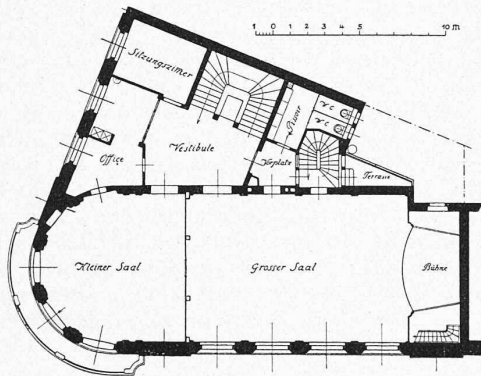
bis 3. Keller, Erdgeschoss und I. Stock. — Grundrisse 1 : 400. — Abb. 4 bis 6. I. Obergeschoss und Dachgeschosse.
